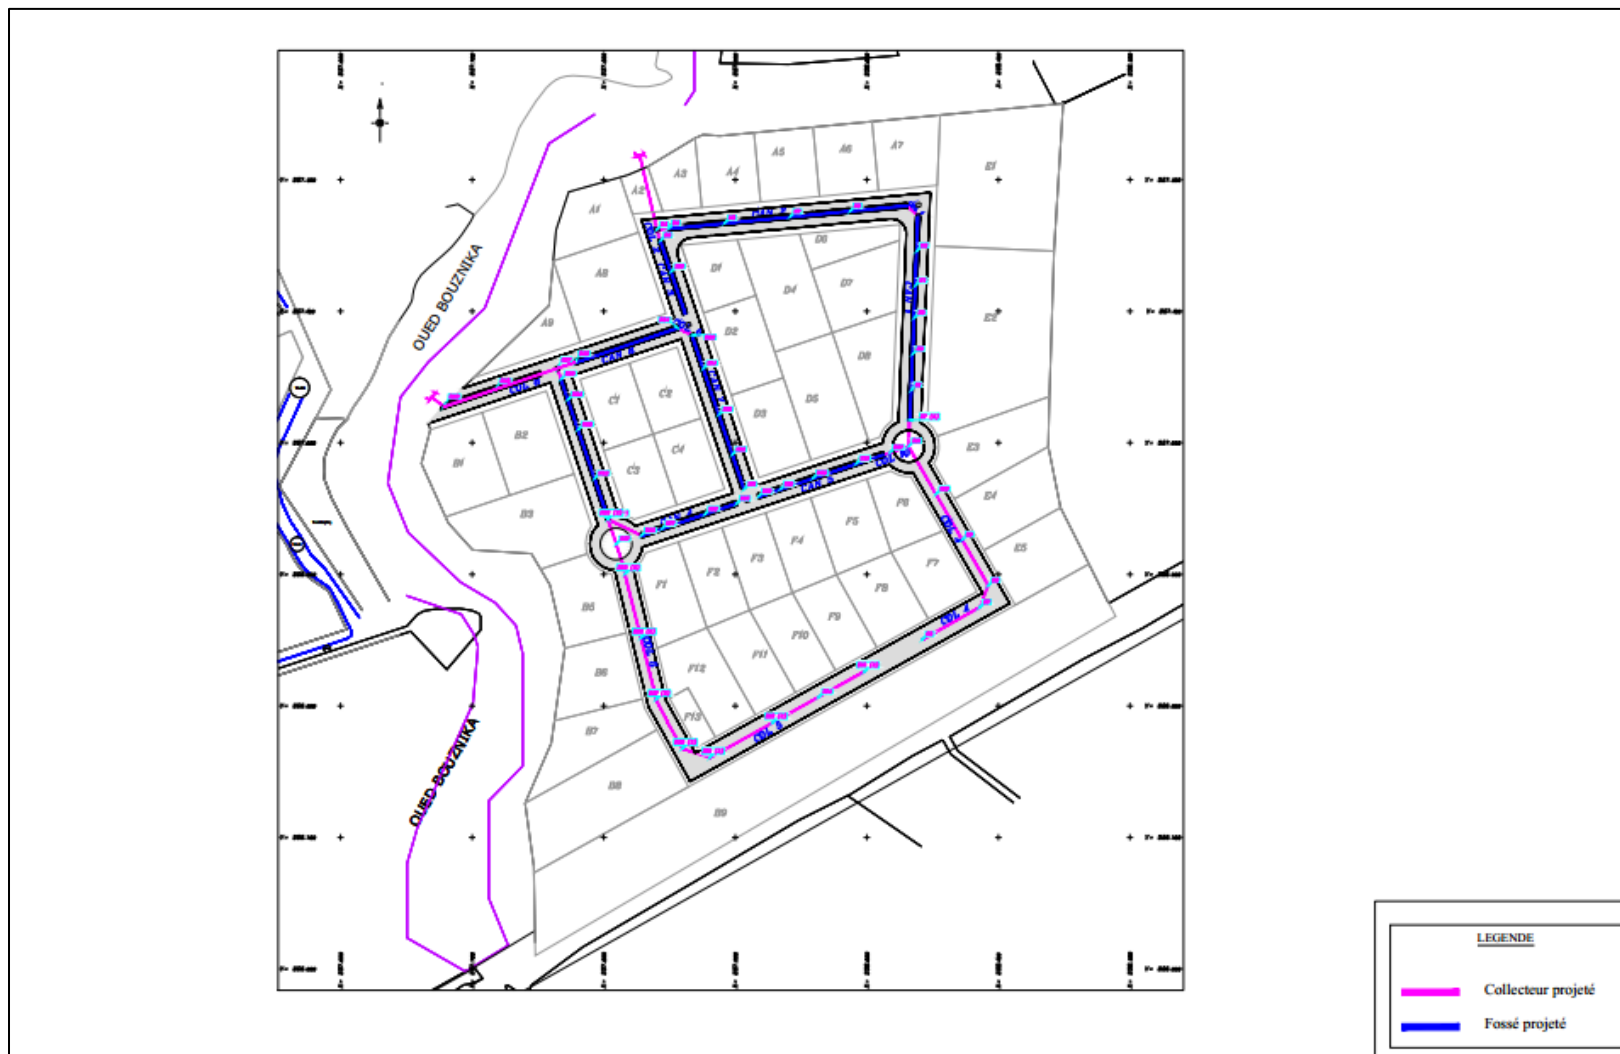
Tracé en plan du réseau d'EP– Extension de la ZI.
